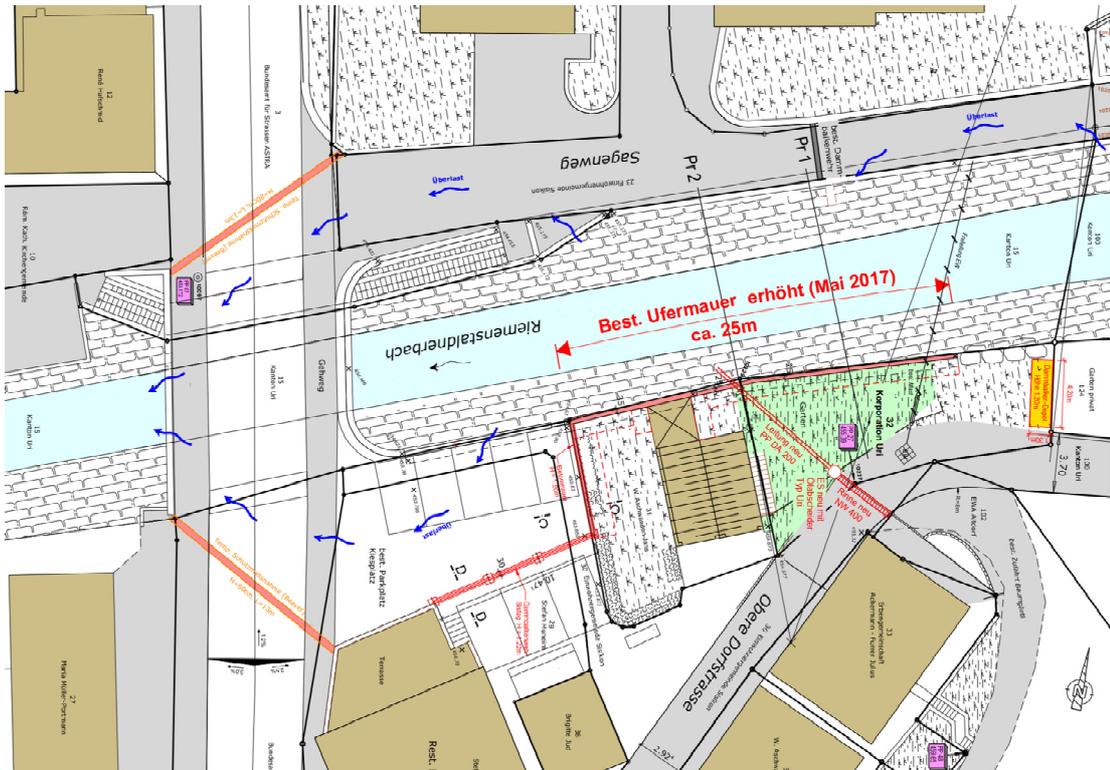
Ausschnitt Situationsplan ausgeführtes Bauwerk mit der fixen Betonmauer (erhöht) in Kombination mit temporären Schutzmassnahmen mit Dambalken beim Rest. Laterne und Beaver-Schläuchen auf der Axenstrasse.
